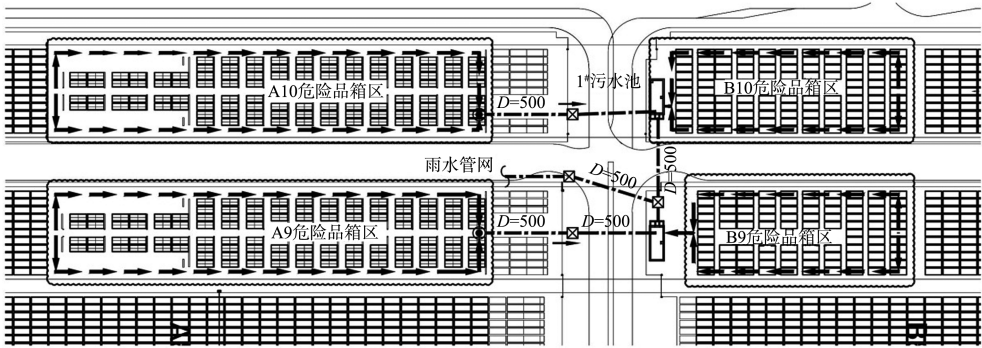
危险货物集装箱堆场排水平面布置（单位：mm）
